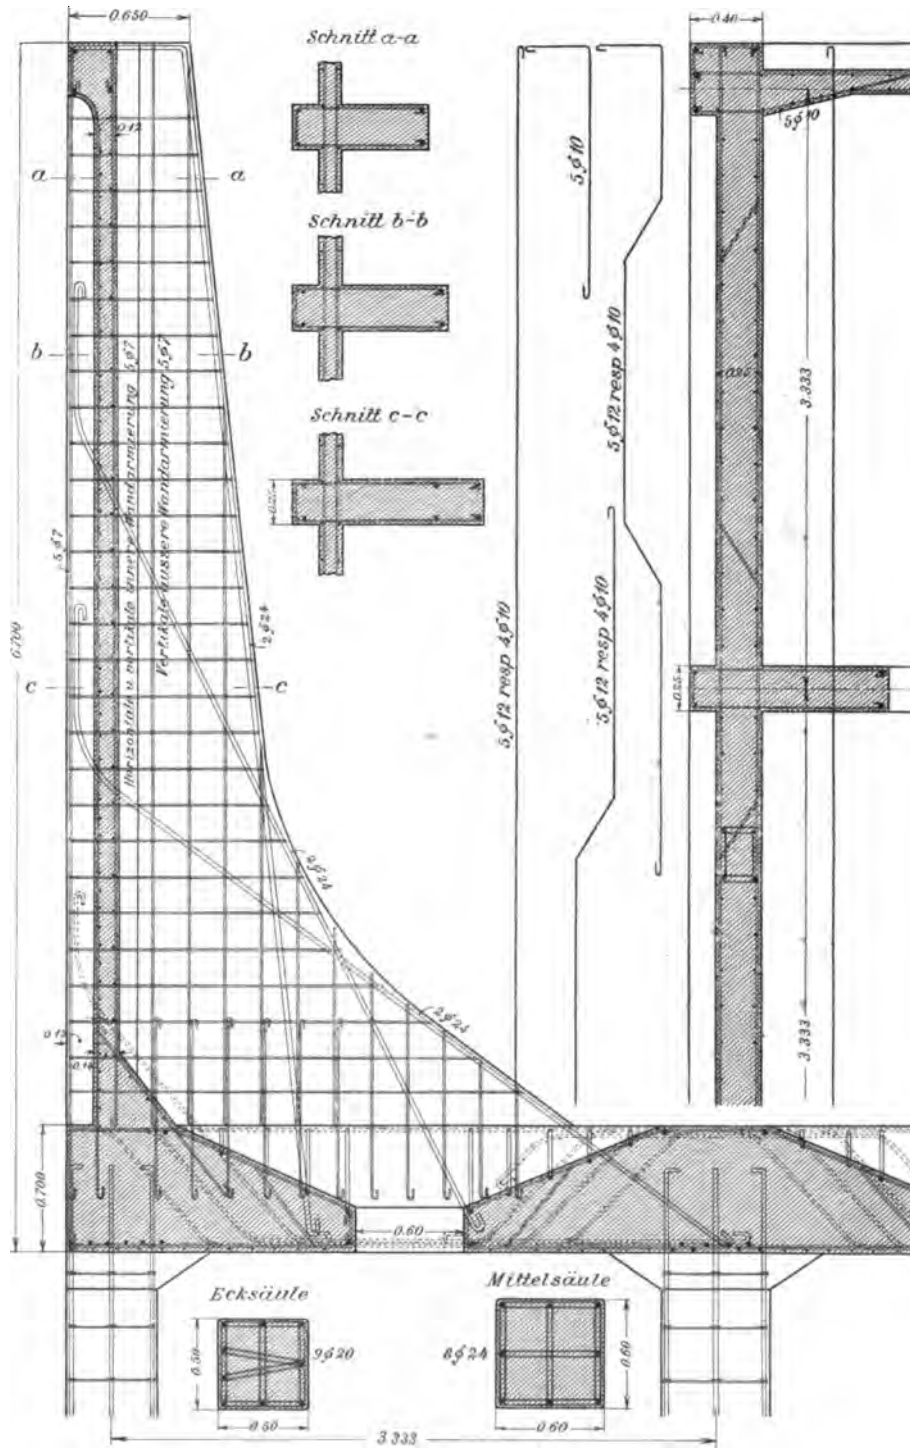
Erzilo Burbach. Details der Eiseneinlagen.
